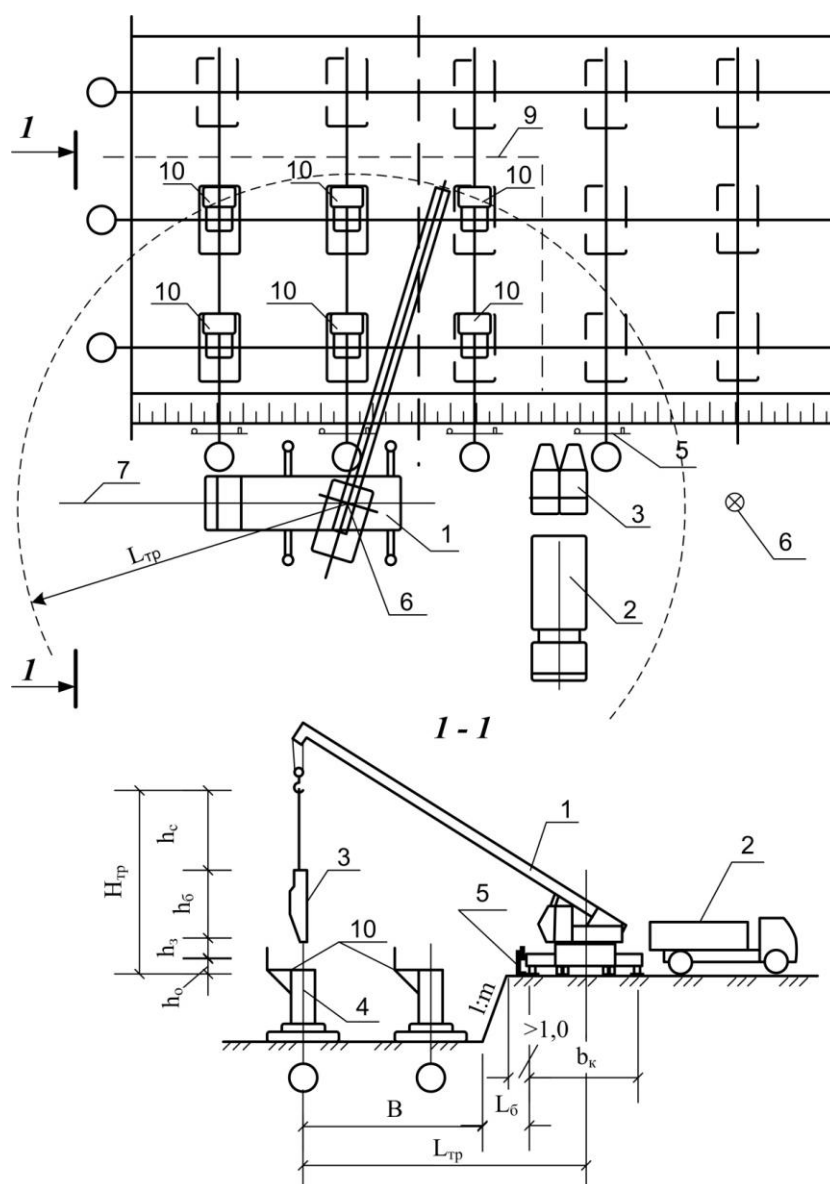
Схема бетонирования фундаментов с бермы котлована:
